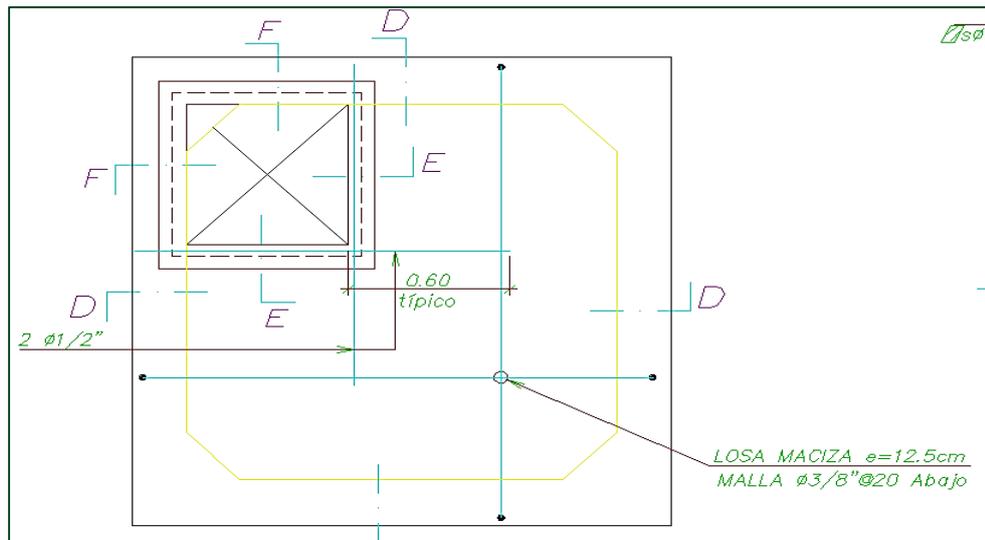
MODELO DE LOSA MACIZA TANQUE ELEVADO
